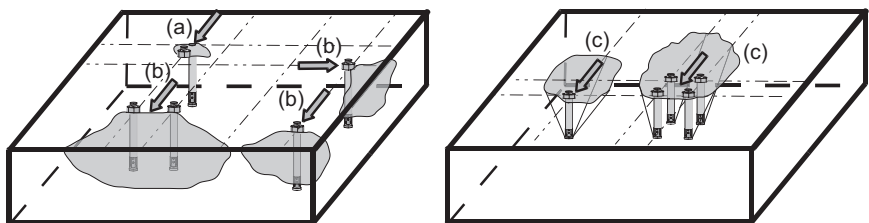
Mögliche Versagensarten eines Befestigungselementes unter Querbelastung in Beton; (a) Stahlbruch, (b) Betonkantenbruch, (c) Betonausbruch lastabgewandte Seite
